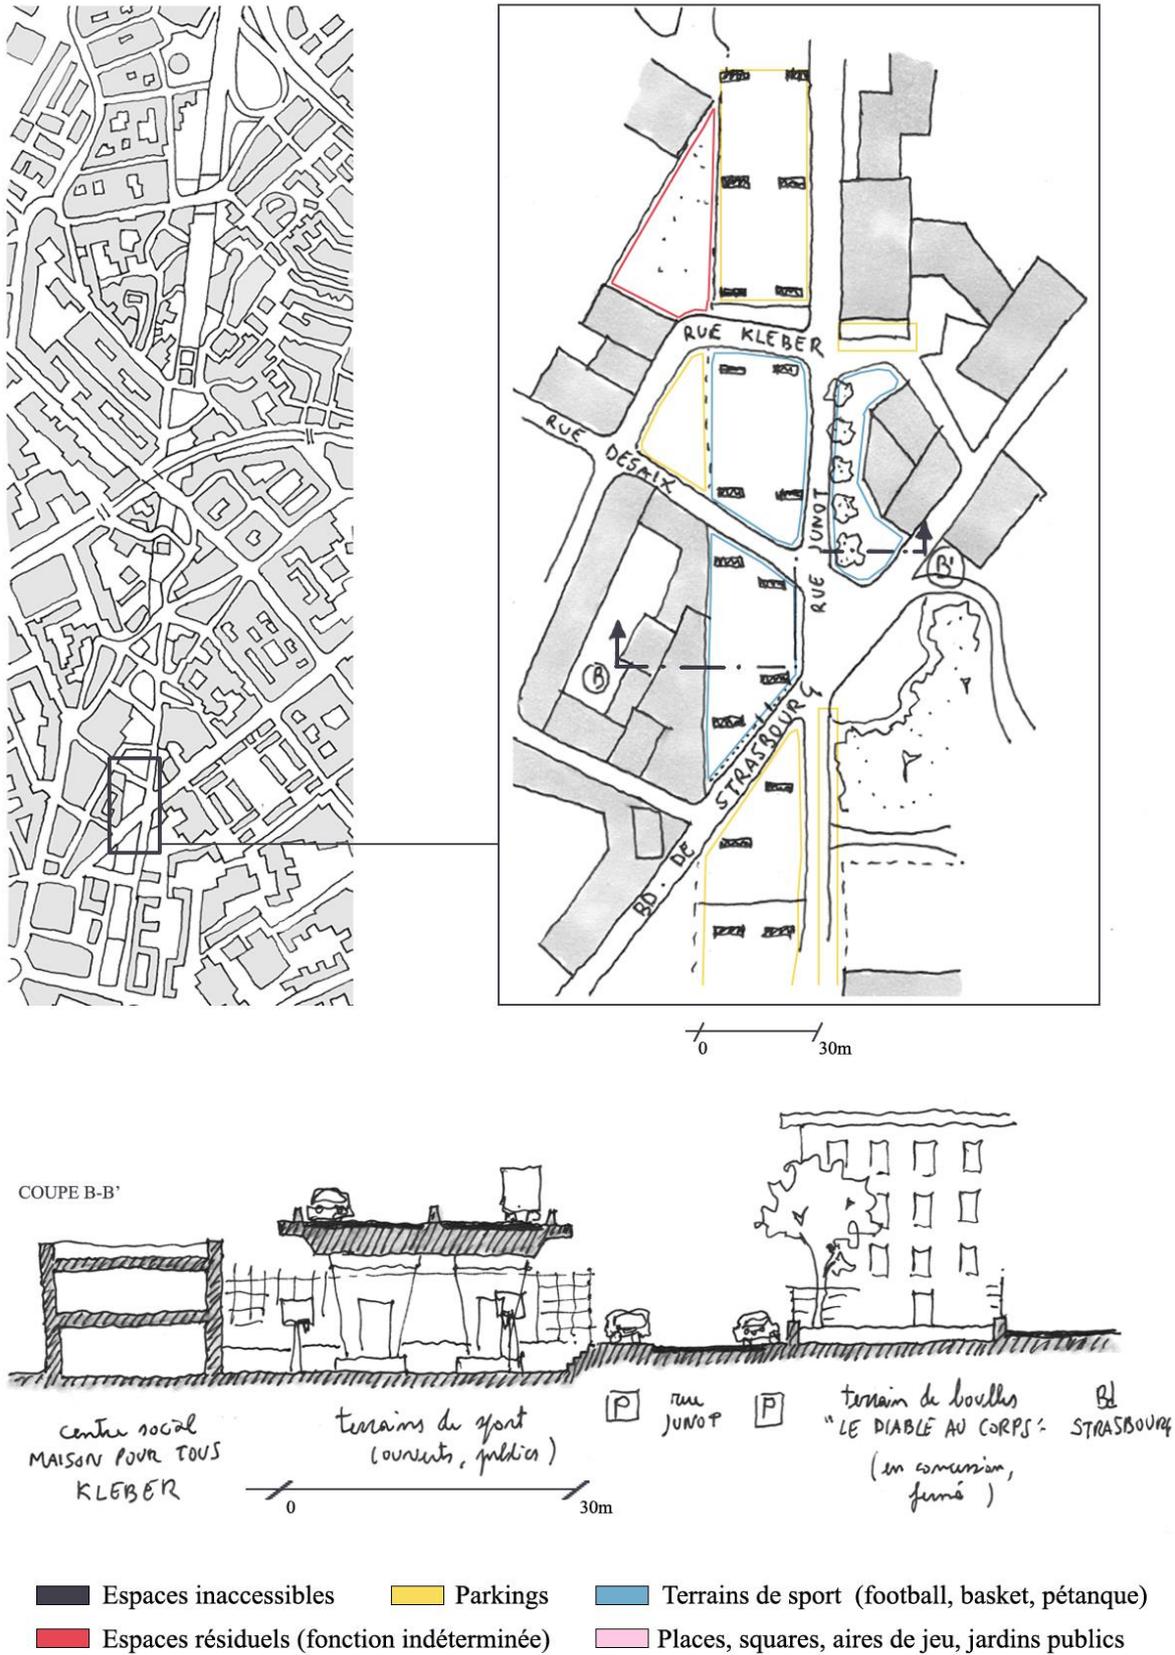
Plan et coupe au niveau des terrains de sport du Bd de Strasbourg (G. Salvia, 2018)
